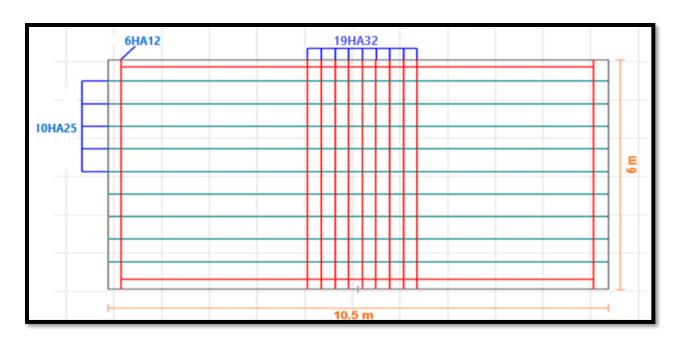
Ferraillage de la semelle – nappe inférieure
